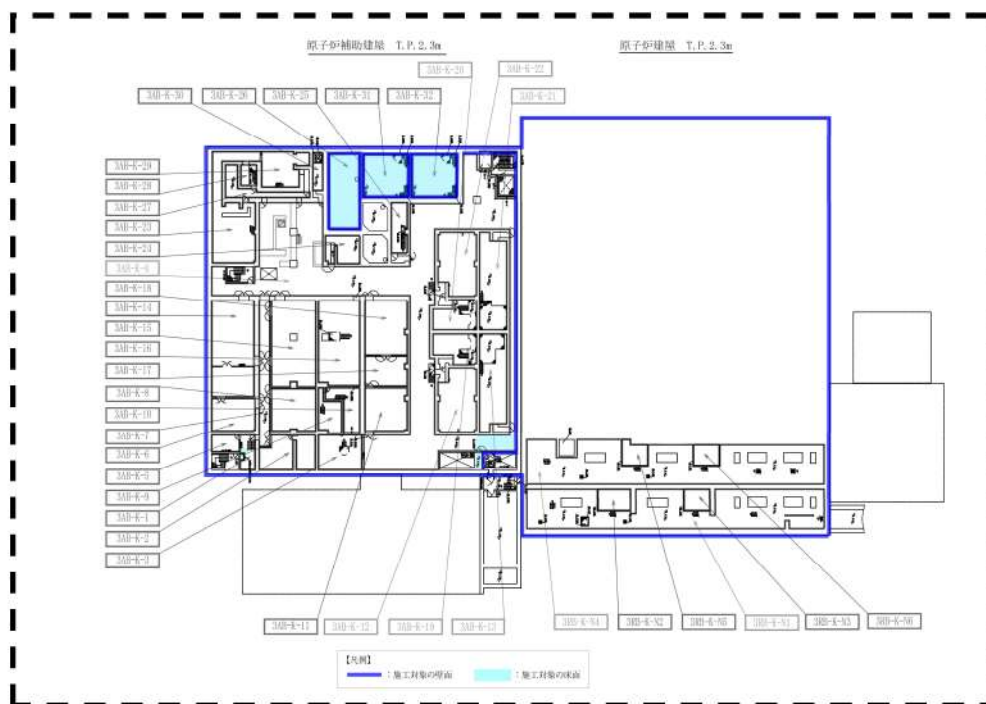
溢水防護対策施工対象の壁及び床の配置図 (9/11)
